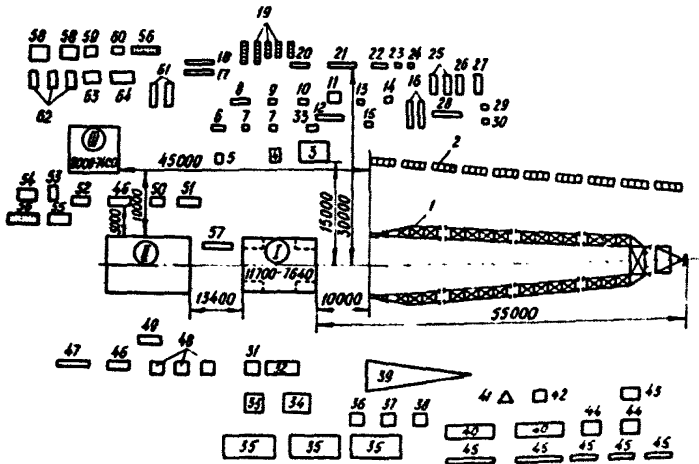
Схема расположения оборудования буровой установки БУ-80Брд при первичном монтаже на строительной площадке
